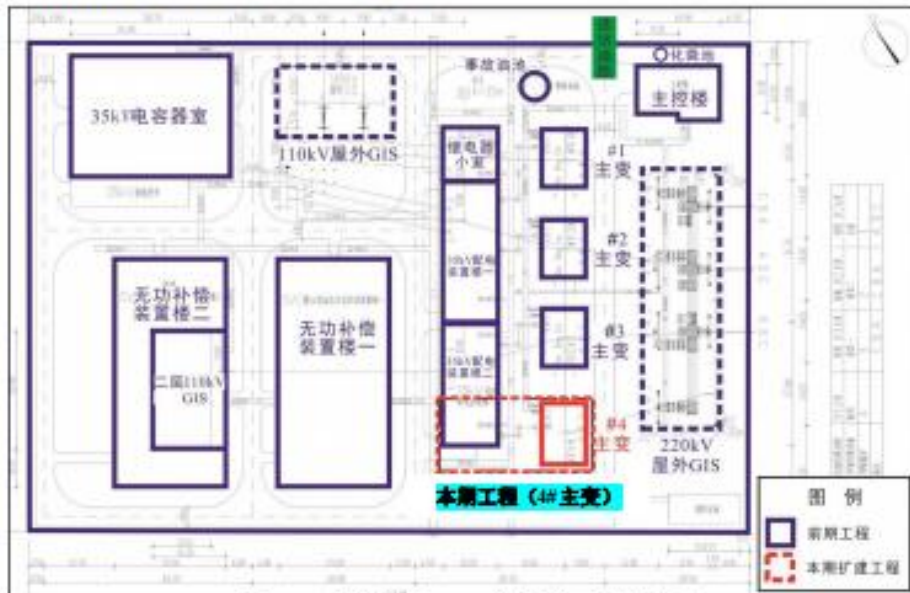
宝钢德盛 22kV 总降变平面布置图
